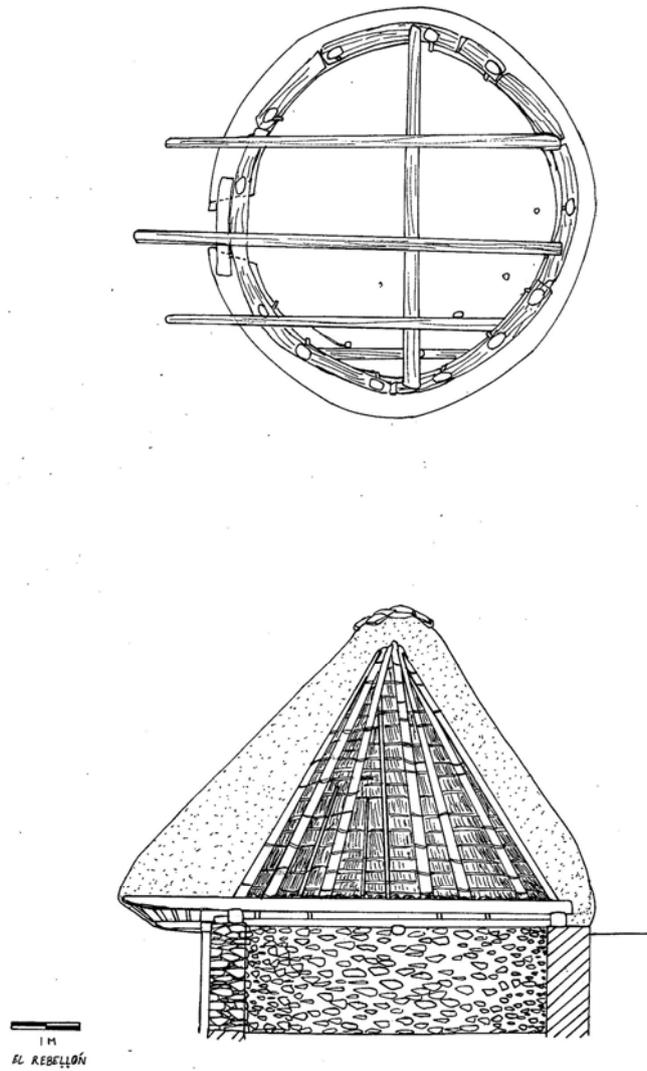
Planta y perfil de la estructura ganadera circular del Rebel.lón / Rebechón.
